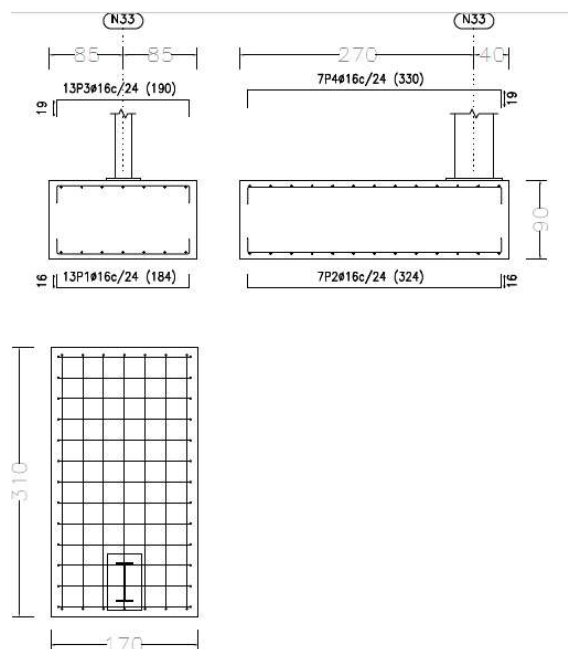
Dimensiones zapata tipo A. (Fuente CYPE 3D).
